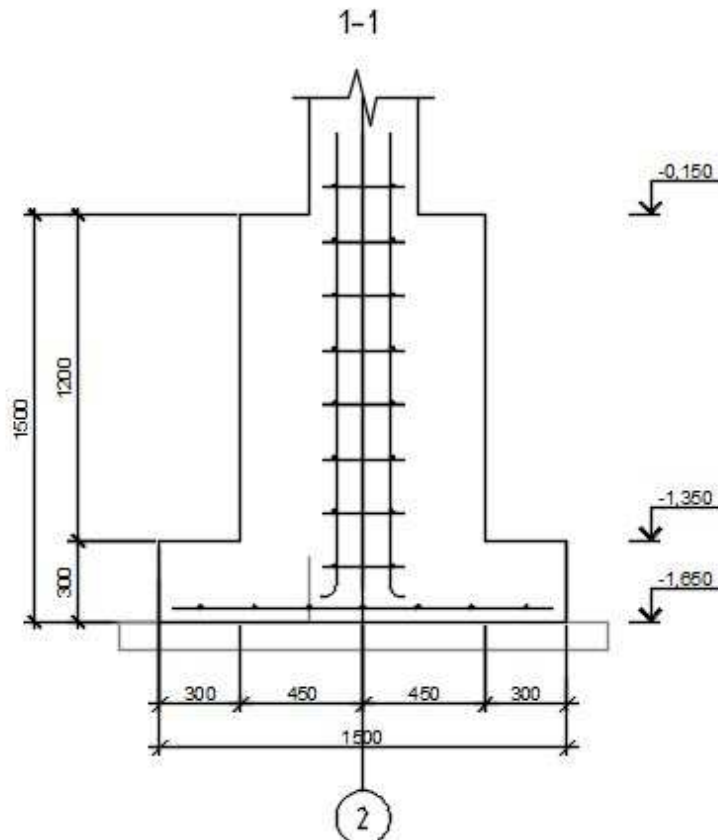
Столбчатый фундамент Фм1 под колонну К2с
